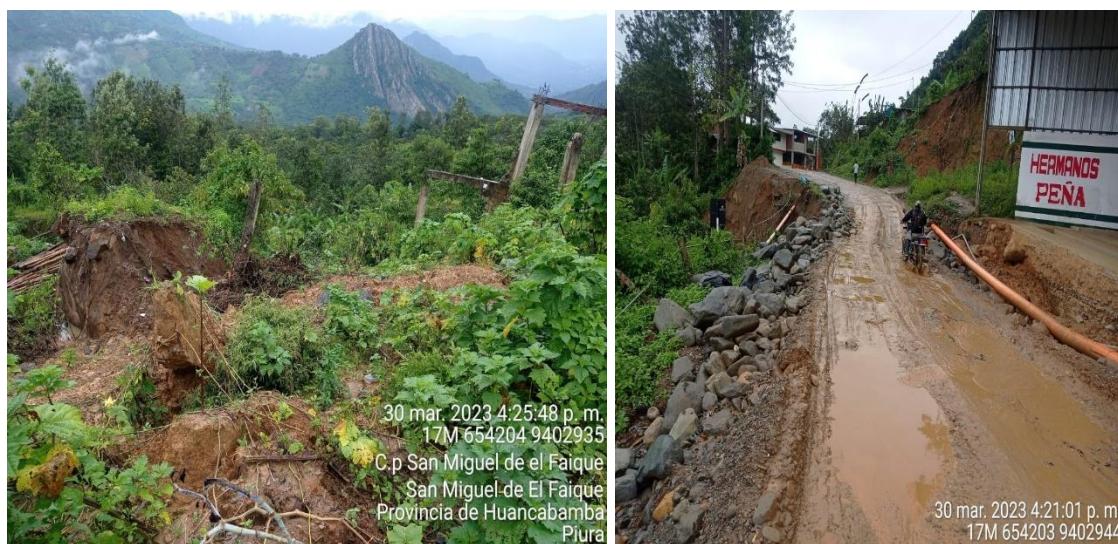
Materiales inestables en el DEM-111 y grietas con saltos de 070 m en la carretera Canchaque - Huancabamba (parte alta de DEM)
